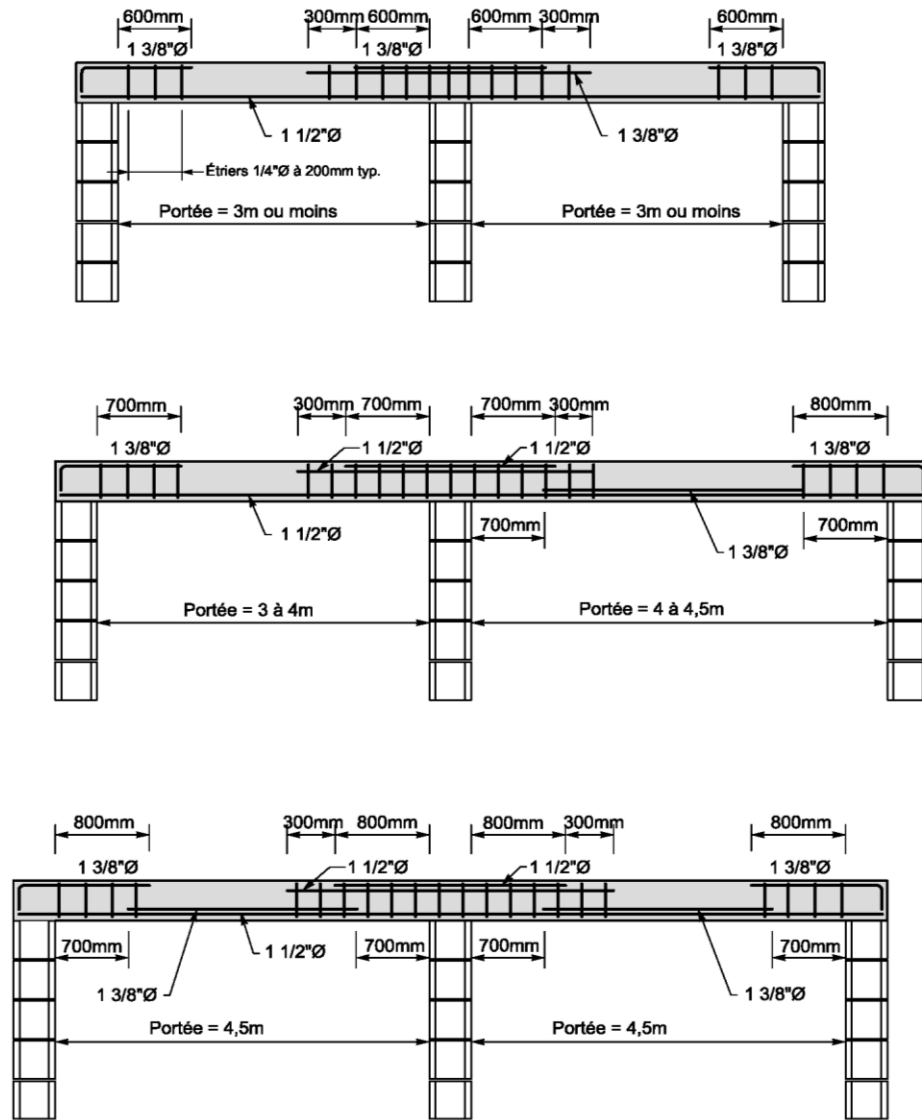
Armature des poutrelles de portée double dans une dalle alvéolée de 200 mm d'épaisseur
